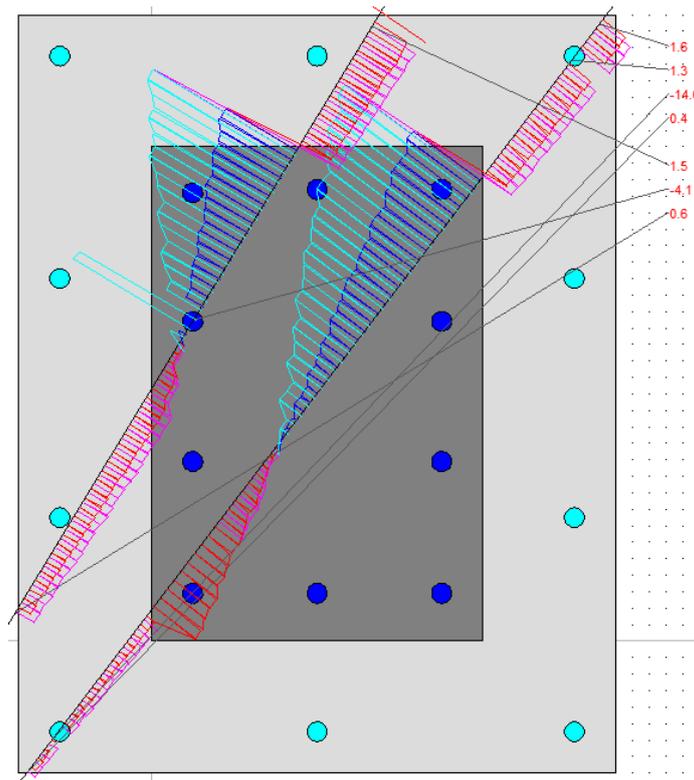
Распределение относительных деформаций и напряжений по поперечному сечению косо сжатой железобетонной колонны, усиленной под нагрузкой железобетонной обоймой, при действии усадки
